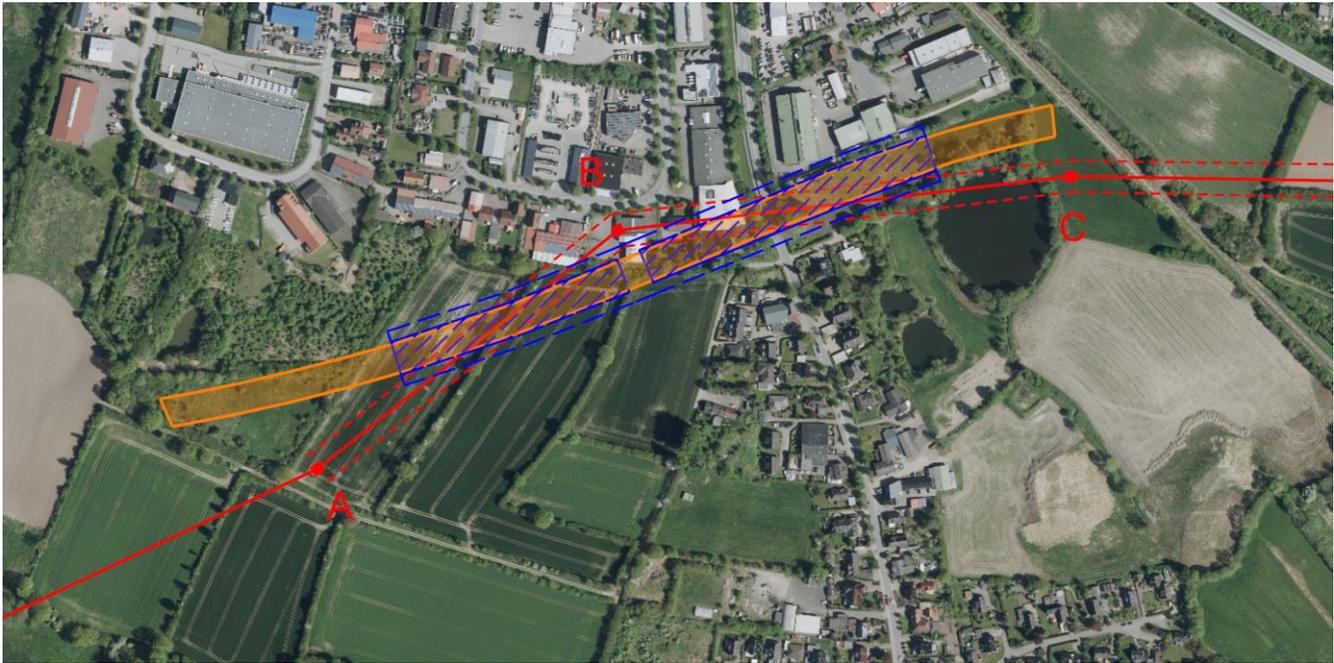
Detailansicht einer möglichen 380-kV-Trasse (rot) in Bündelung mit der geplanten Autobahn A 20 (orange) und dem erforderlichen Schutzgerüst (blau) (Trasse der Autobahn gemäß aktueller Planung der DEGES)
